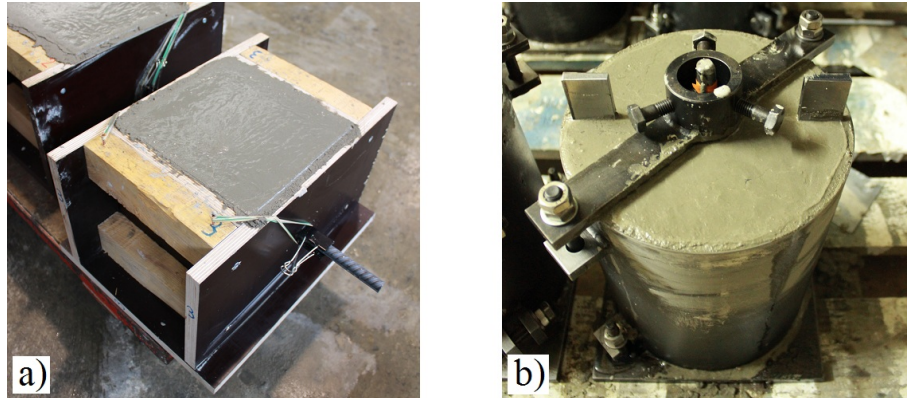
Coulage des éprouvettes d'arrachement : a) armature horizontale, b) armature verticale.
